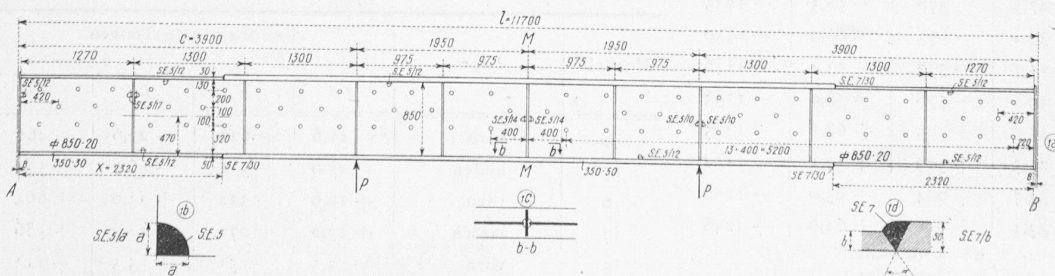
Durch elektrische Schweissung aus zwei Feldern zusammengesetzter Blechträger. Gewicht 4,86 t.
